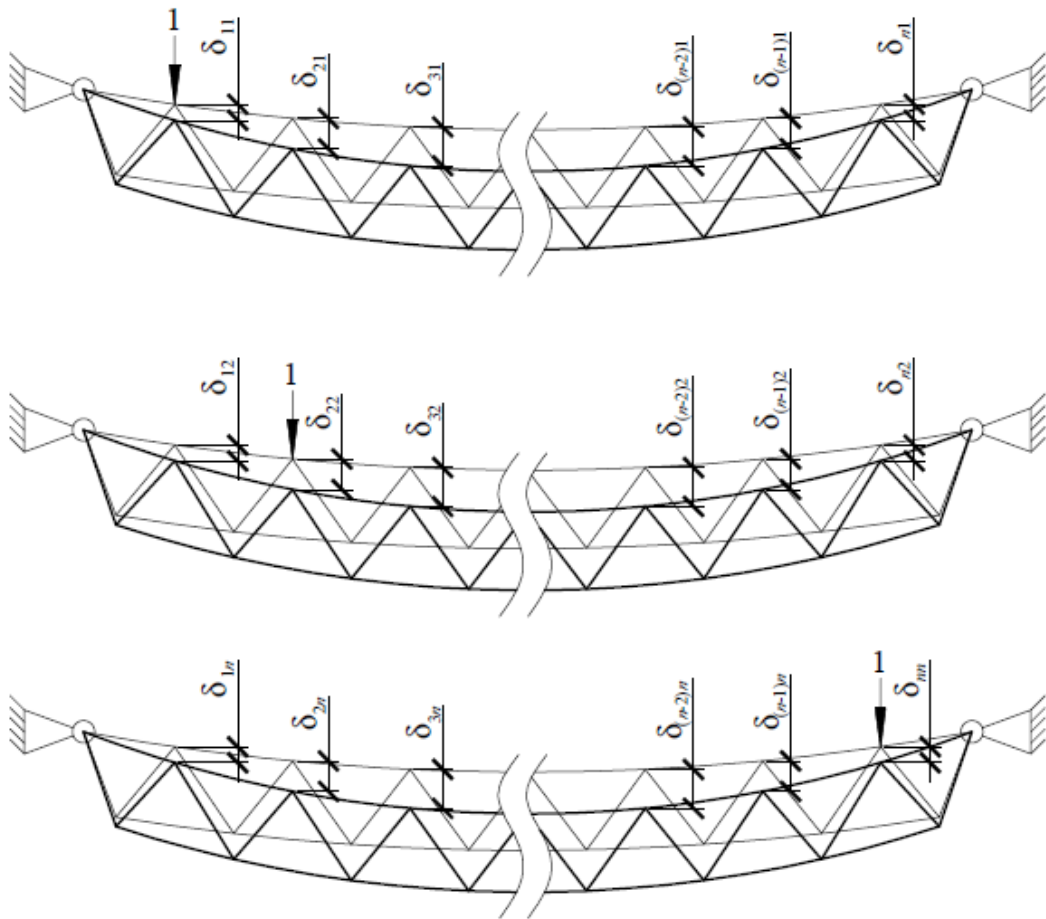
Схема к определению удельных перемещения точек сосредоточения
